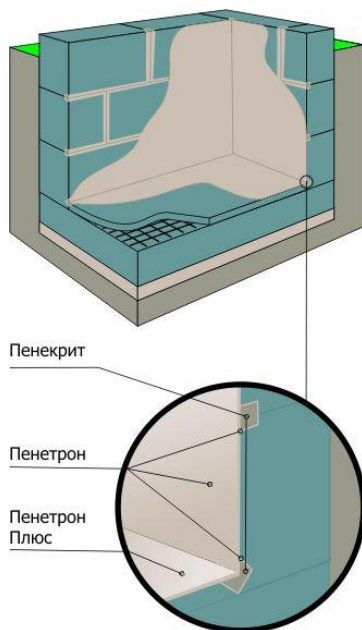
Гидроизоляция конструкции из бетонных блоков
